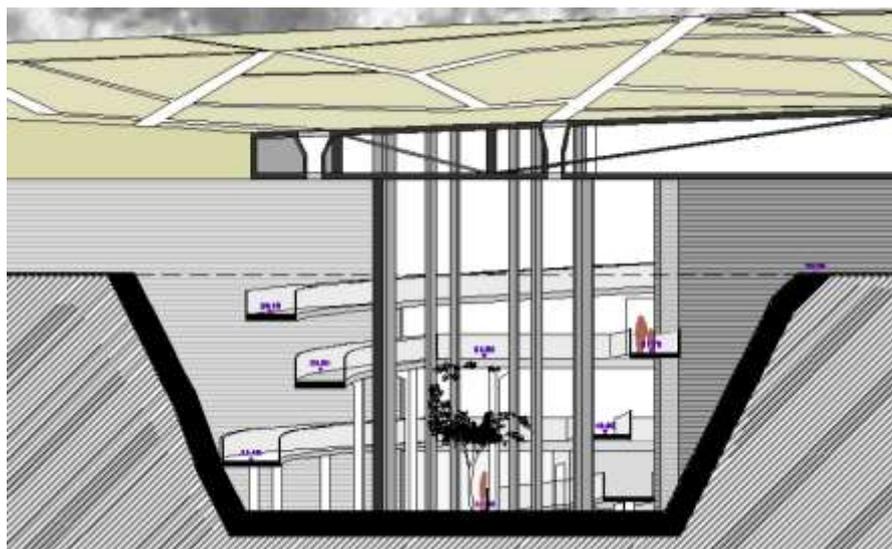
Estrutura da rampa de acesso e se apoio à cobertura.
